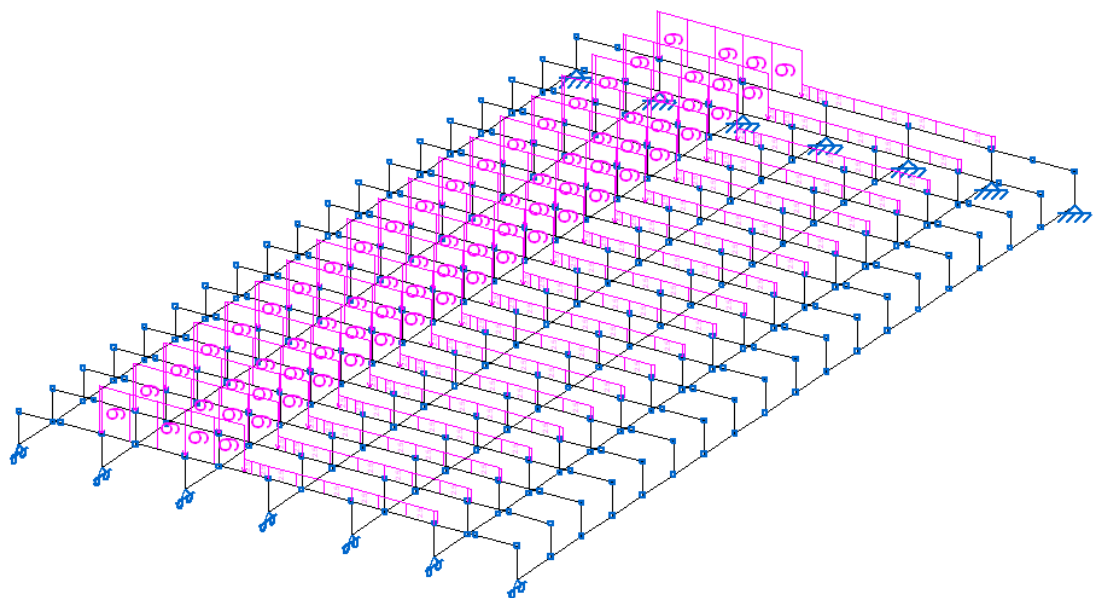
Posición de la sobrecarga en carriles.Caso1.
